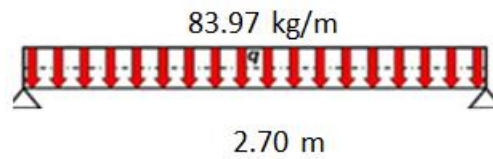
Carga distribuida en la viga eje 1 entre a-b
